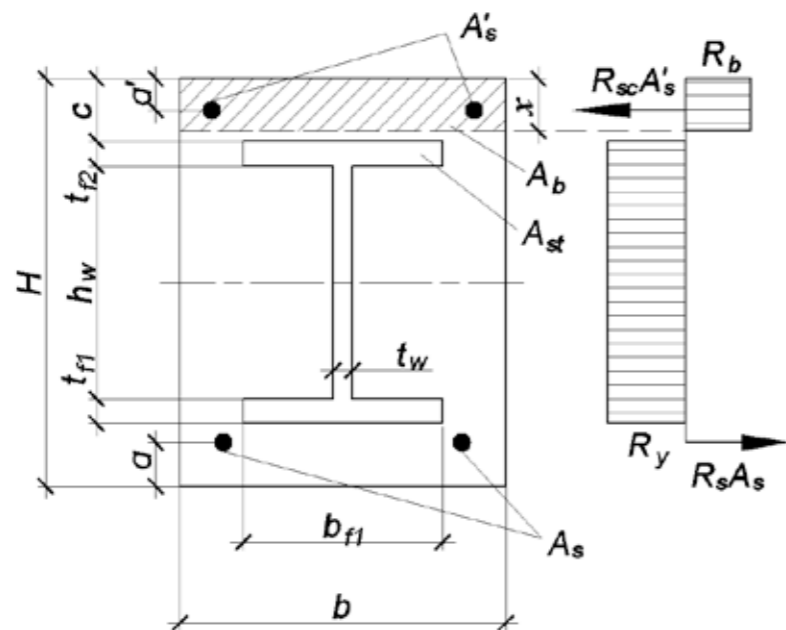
Случай, когда нейтральная ось не пересекает профиль жесткой арматуры и находится ниже верхней гибкой арматуры в обетонированной балке прямоугольного сечения
